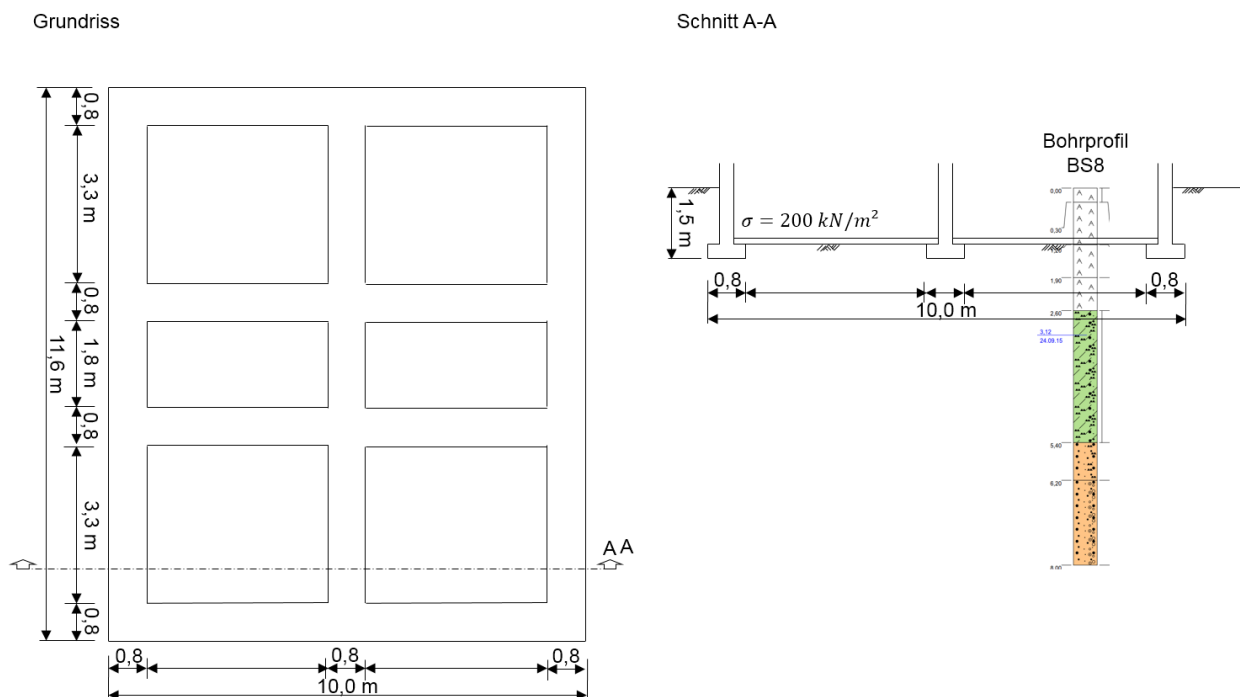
Repräsentatives Modellhaus für die Setzungsberechnungen, Grundriss und Schnitt mit maßgebenden Bodenprofil BS8
